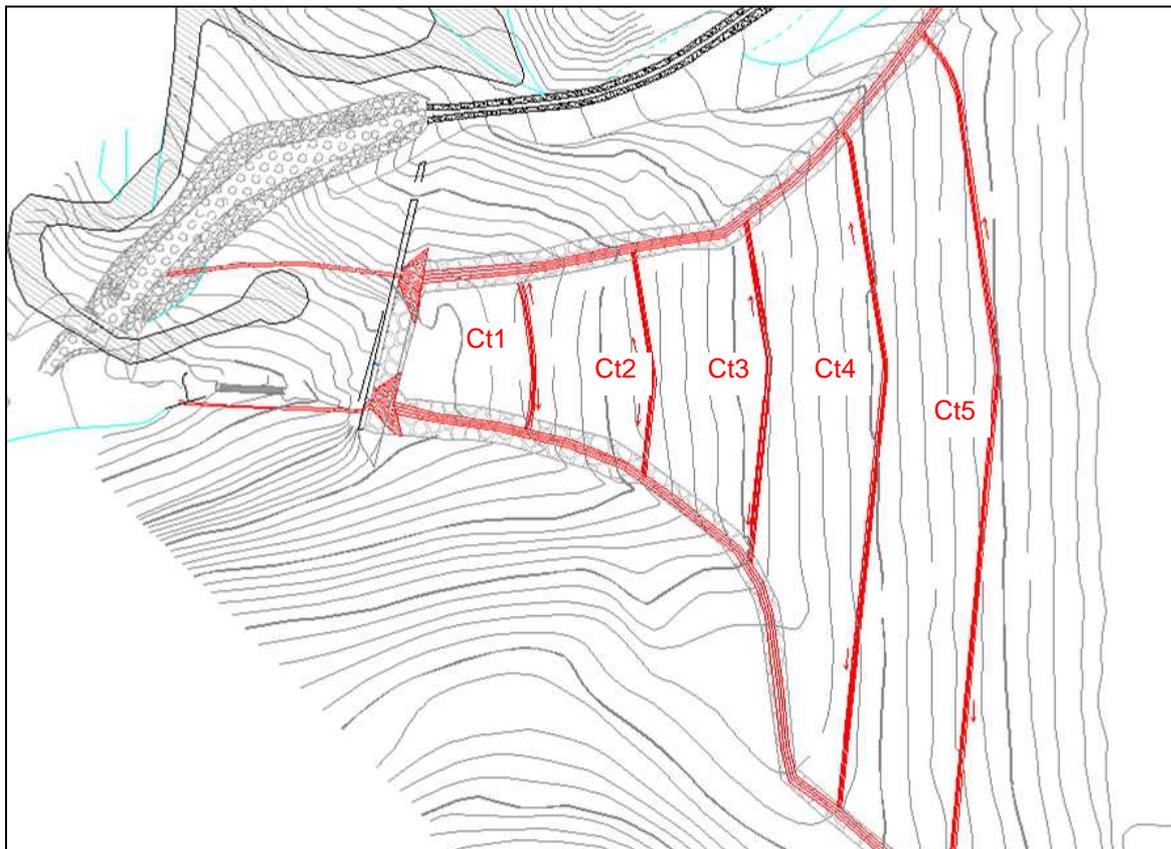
Localisation des caniveaux transversaux Ct1 à 4
